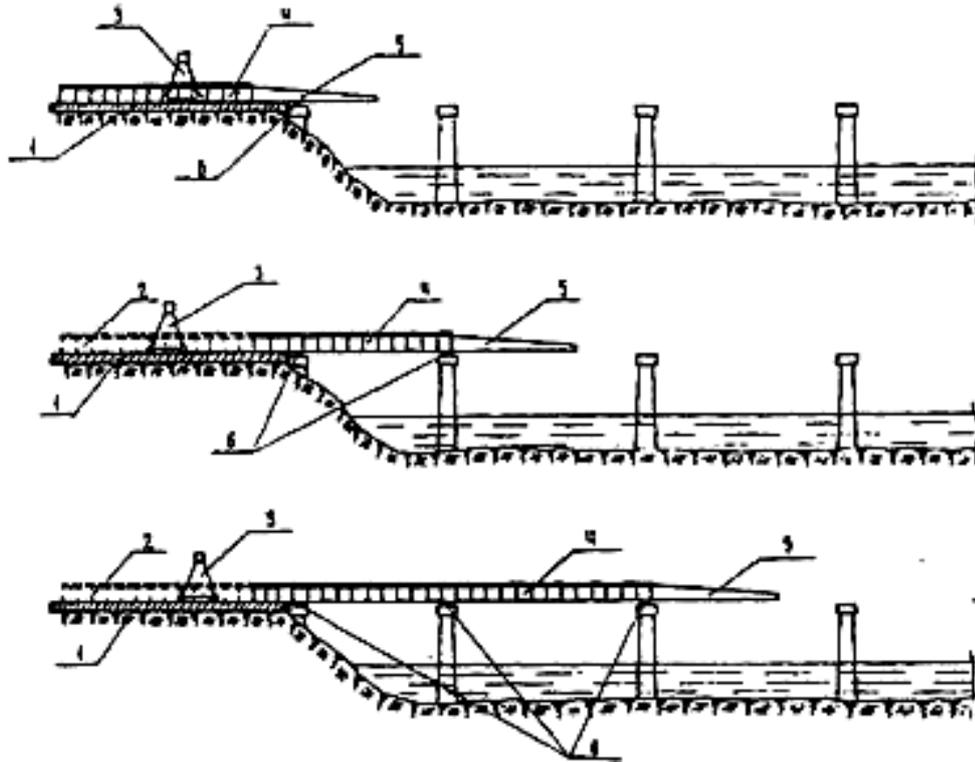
Последовательность сборки и продольной надвигки пролетного строения: 1- сборочный стенд; 2-блоки; 3-монтажный кран; 4-собранный часть пролетного строения; 5- аванбек; 6-накаточные устройства [77]
